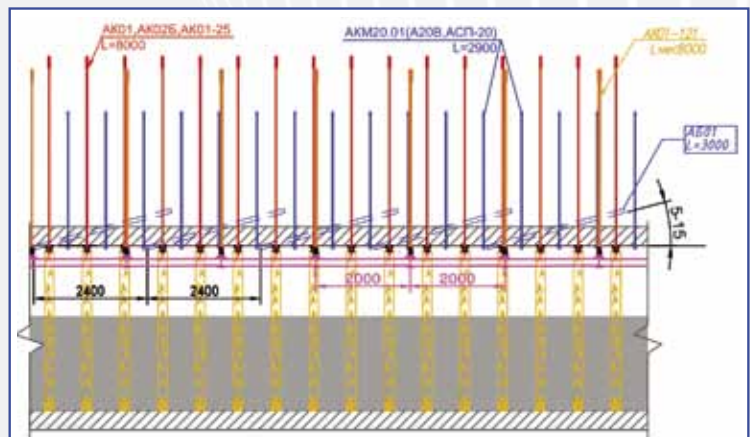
Схема крепи демонтажной камеры с установкой анкеров АБ01
